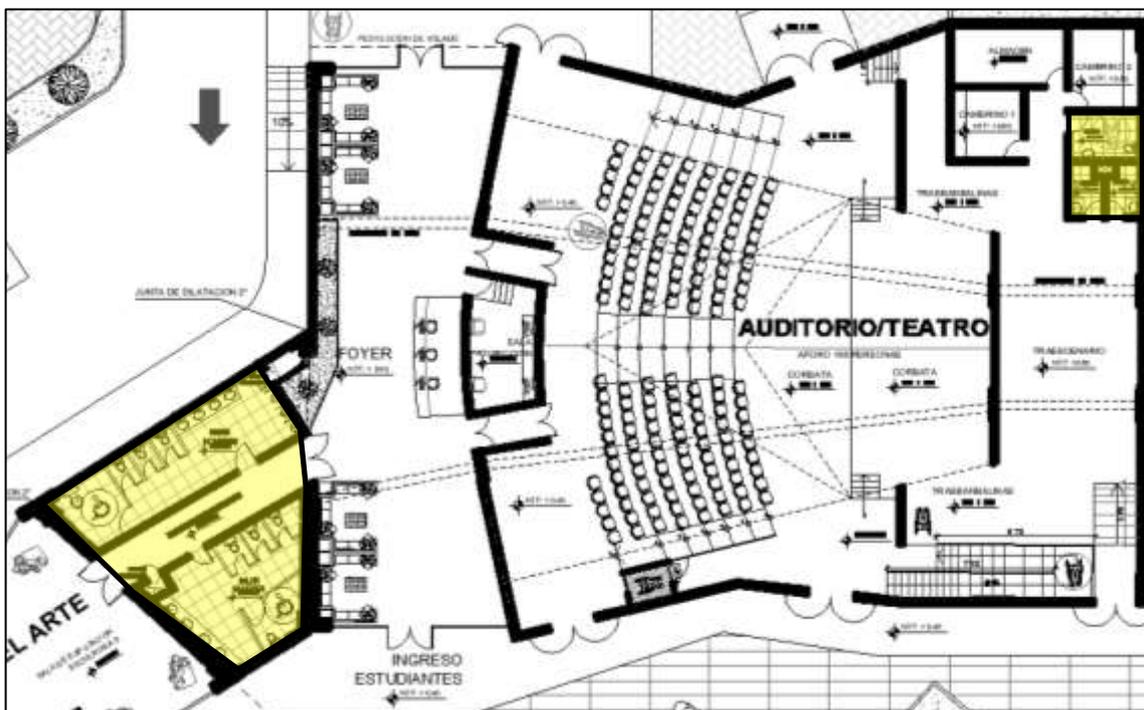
Planta primer nivel del proyecto-Auditorio. FUENTE: Elaboración propia.
